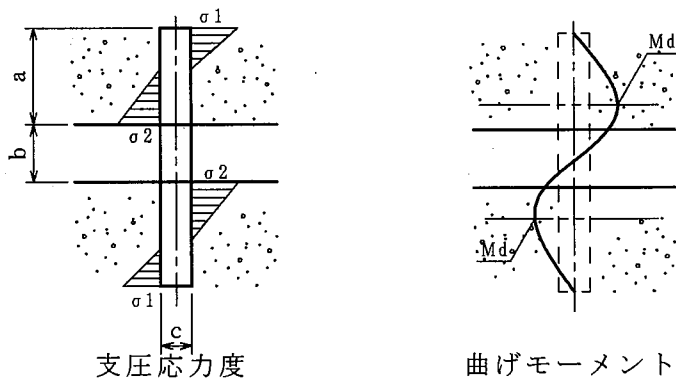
H 形鋼に作用する支圧応力度・曲げモーメント
